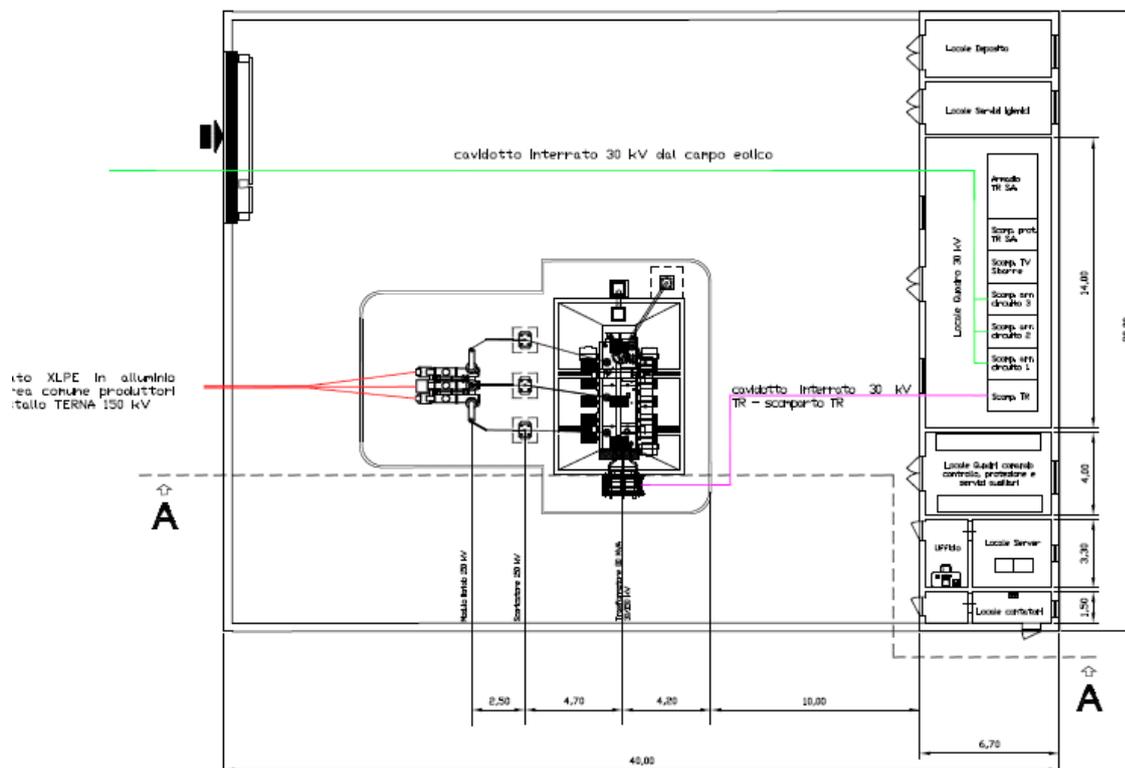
Planimetria stazione di trasformazione 30/150 kV
